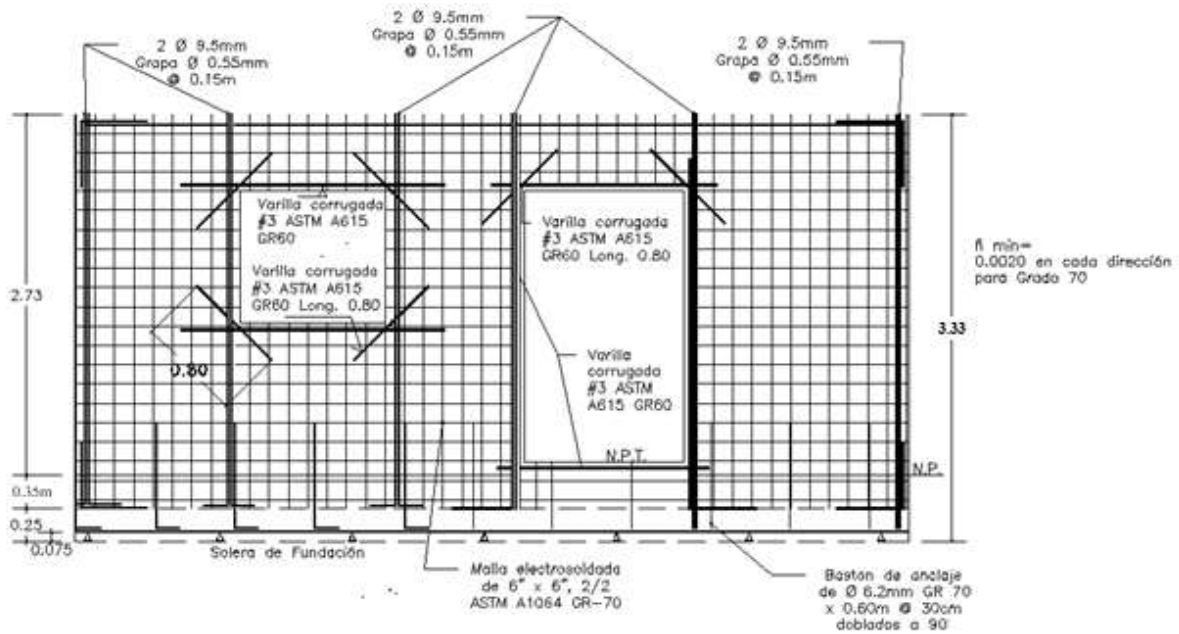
c Detalle típico de refuerzo en pared de concreto reforzado, para vivienda de dos plantas, con acero grado 70
